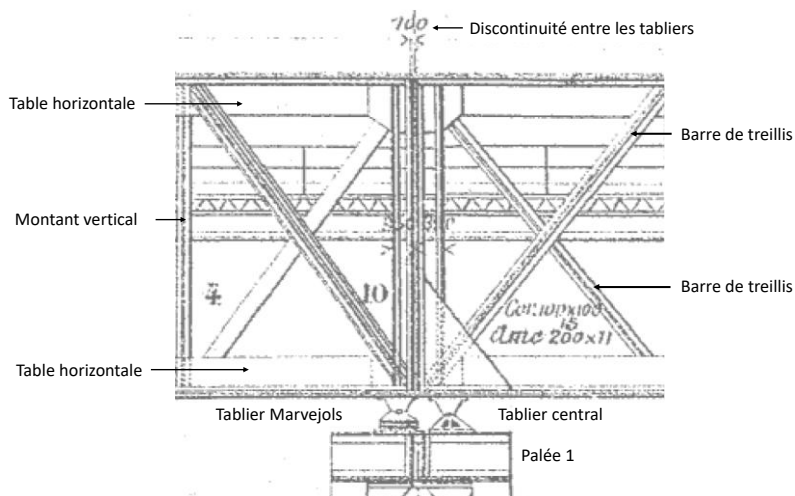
Viaduc de Garabit. Poutre principale des tabliers. Le tablier est discontinu aux palées (Eiffel, 1888a, p. Planche 172)
